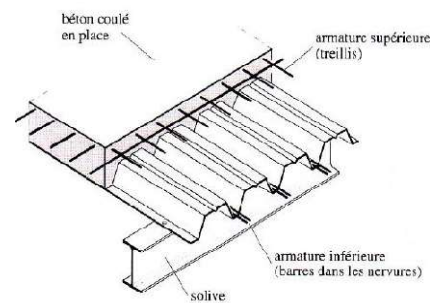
Une perspective d'un plancher collaborant. Source : <http://www.plus sur poteau métallique.html>.
